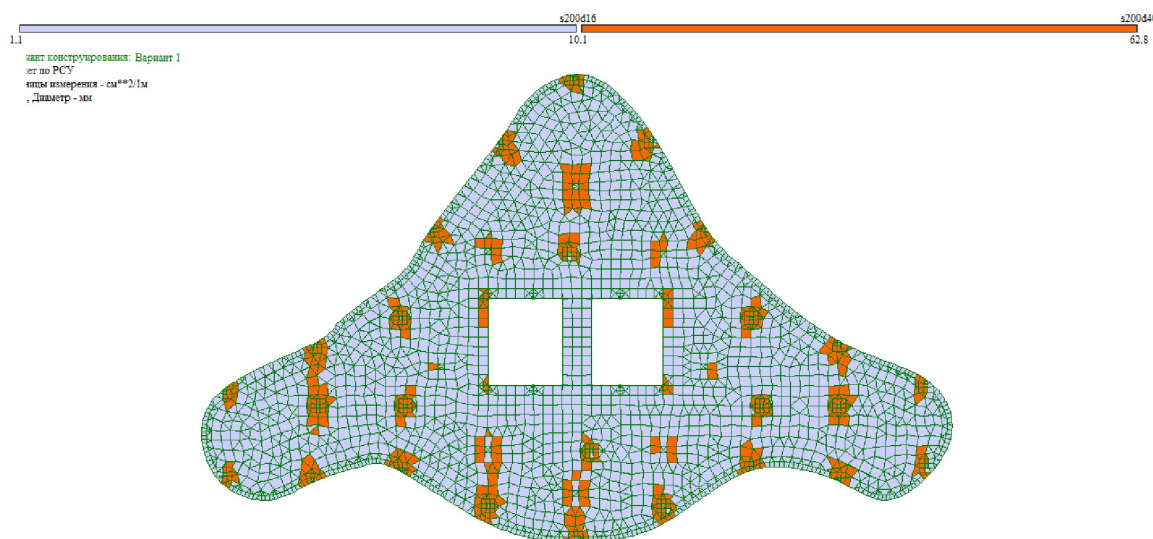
Армирование перекрытия (Верхняя по X)
